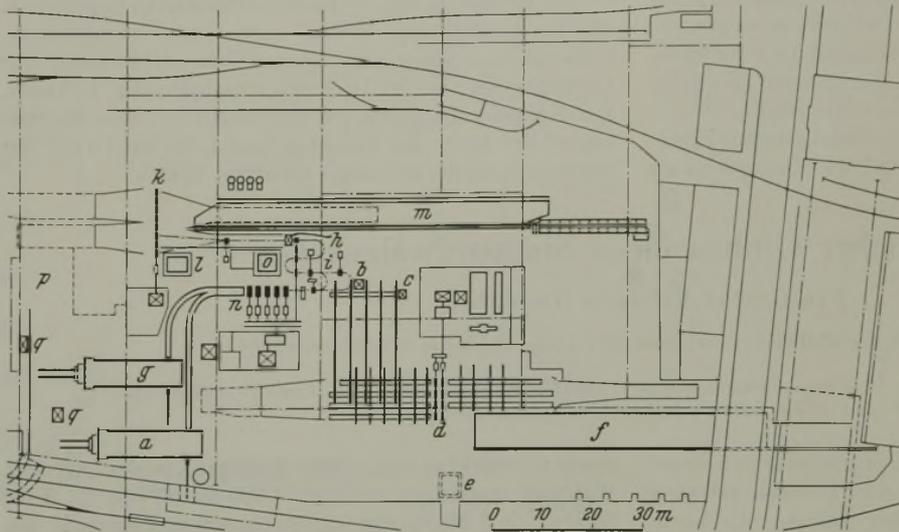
Grundriß der Walzwerksanlage nach dem Umbau.
